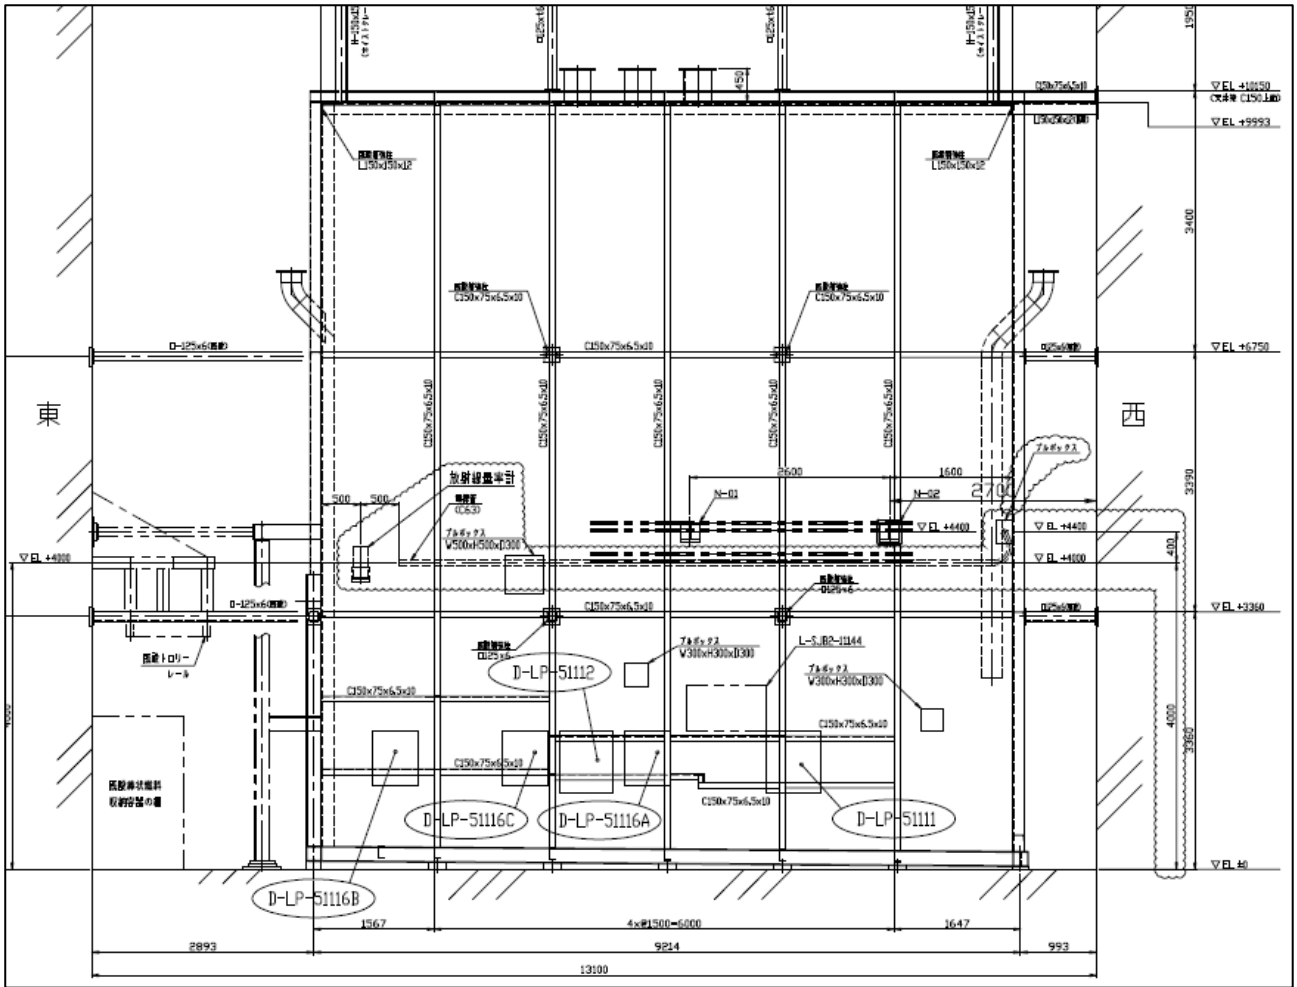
A1-3 炉室 (S) 立面图 (北面)
